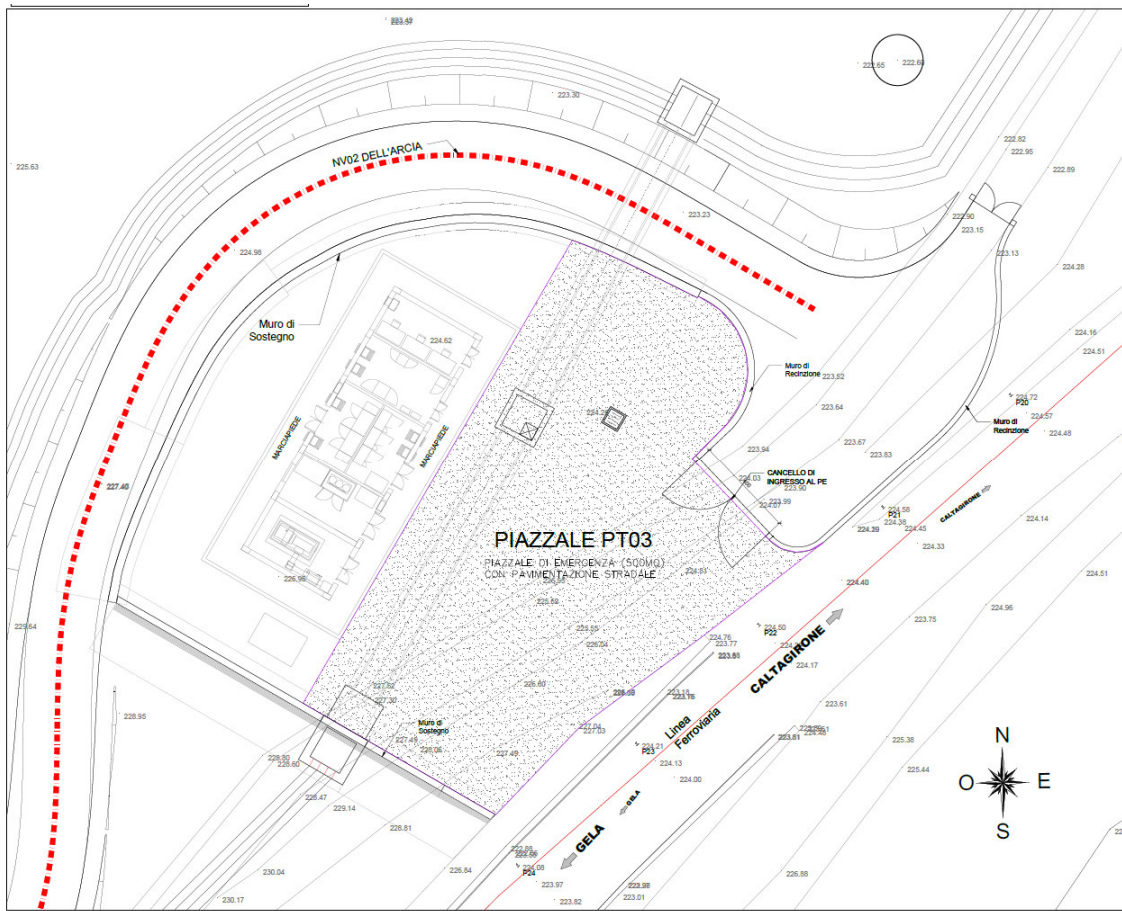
PT03 Planimetria piazzale di emergenza GA dell'Arcia imbocco nord
